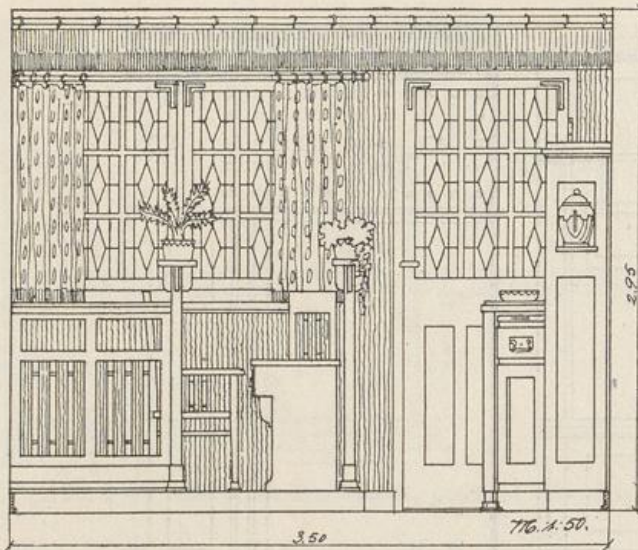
Erkereinbau im EBzimmer mit Nähtisch der Frau, zu Grundriß Abb. 222.
